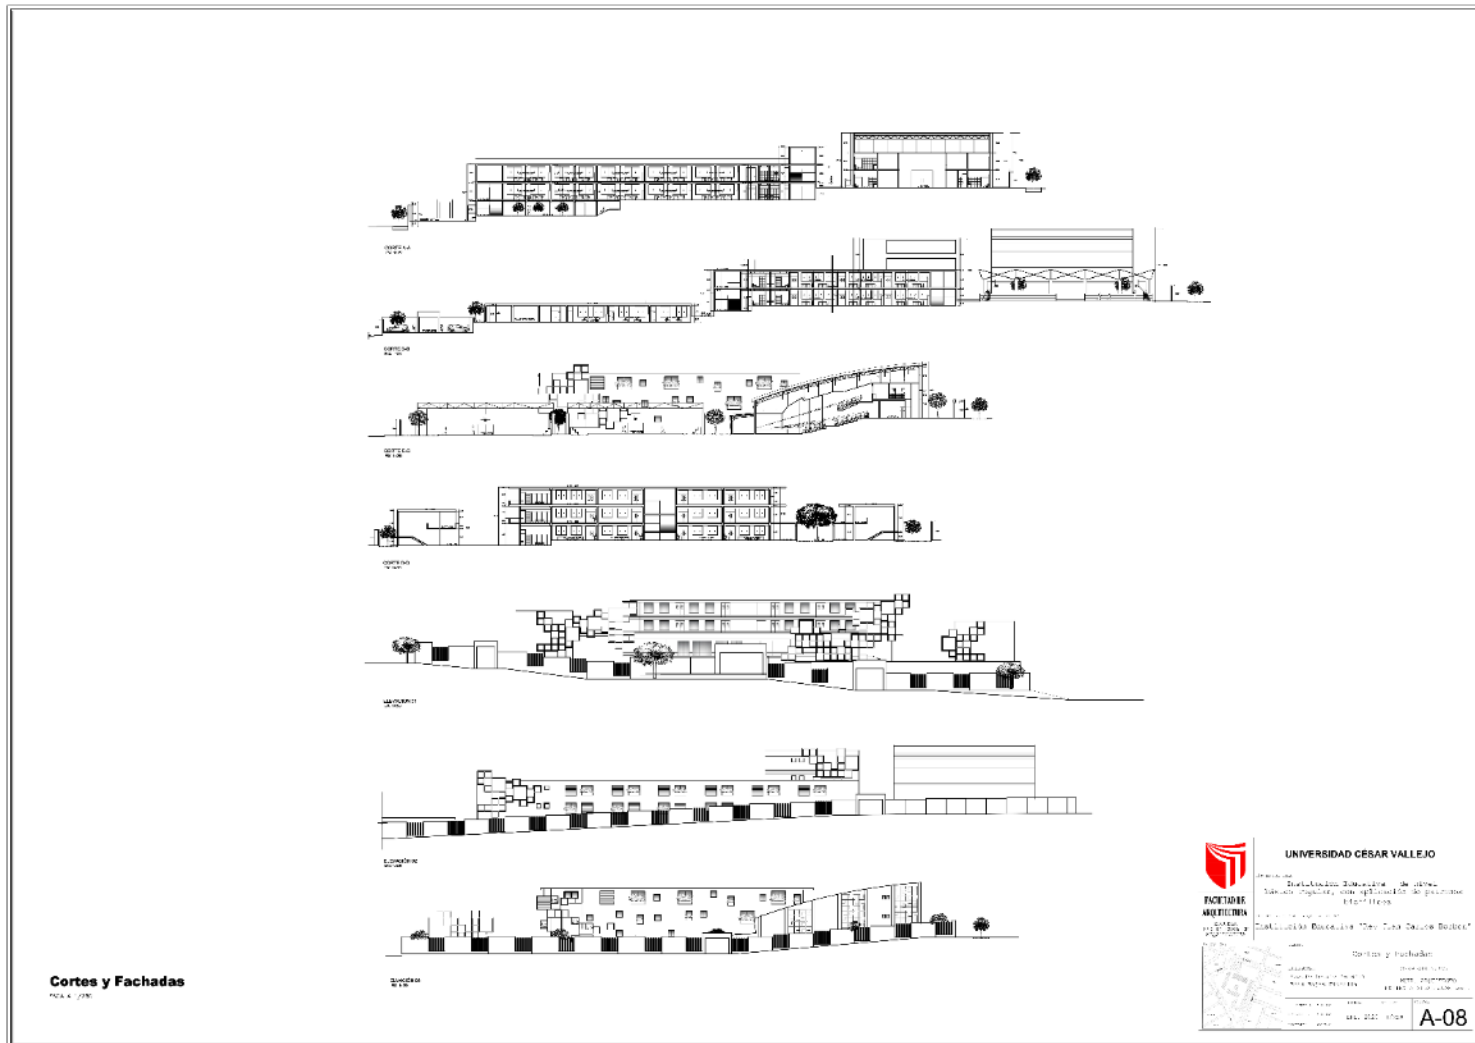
Plano de Corte y elevaciones*, Fuente: elaboración propia
